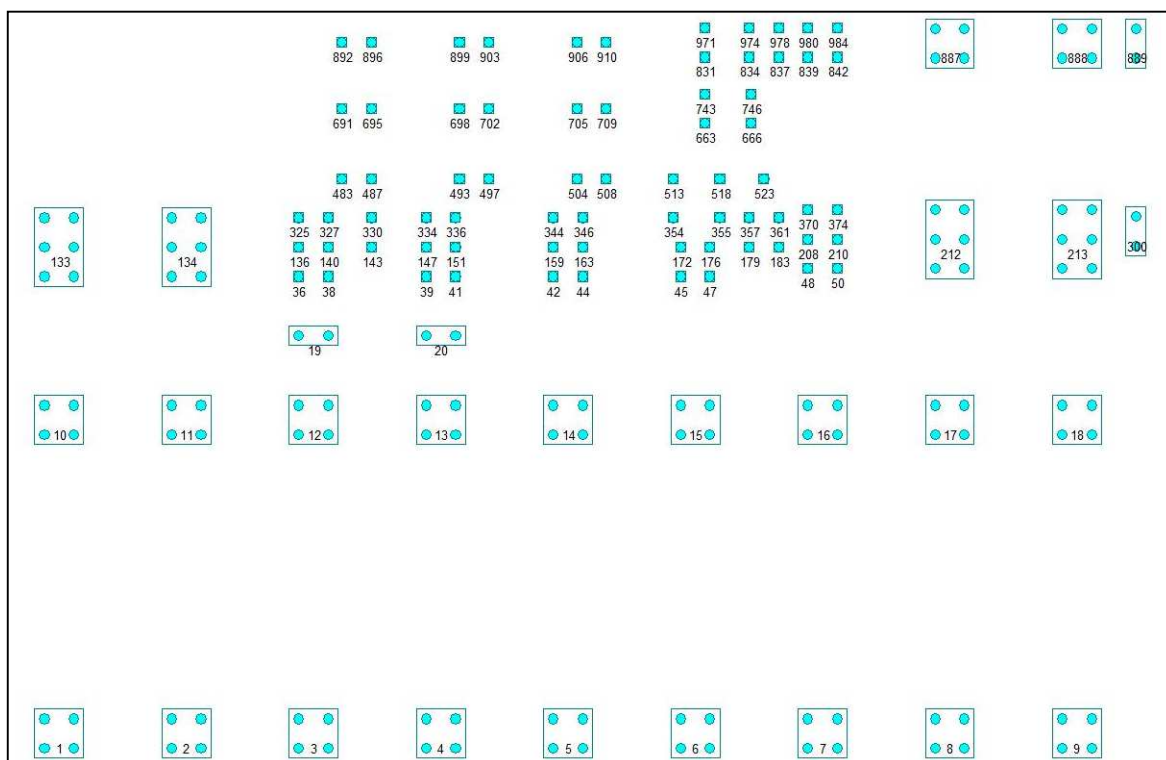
Stato progetto elementi di fondazione (in ciano gli elementi con verifica positiva)
